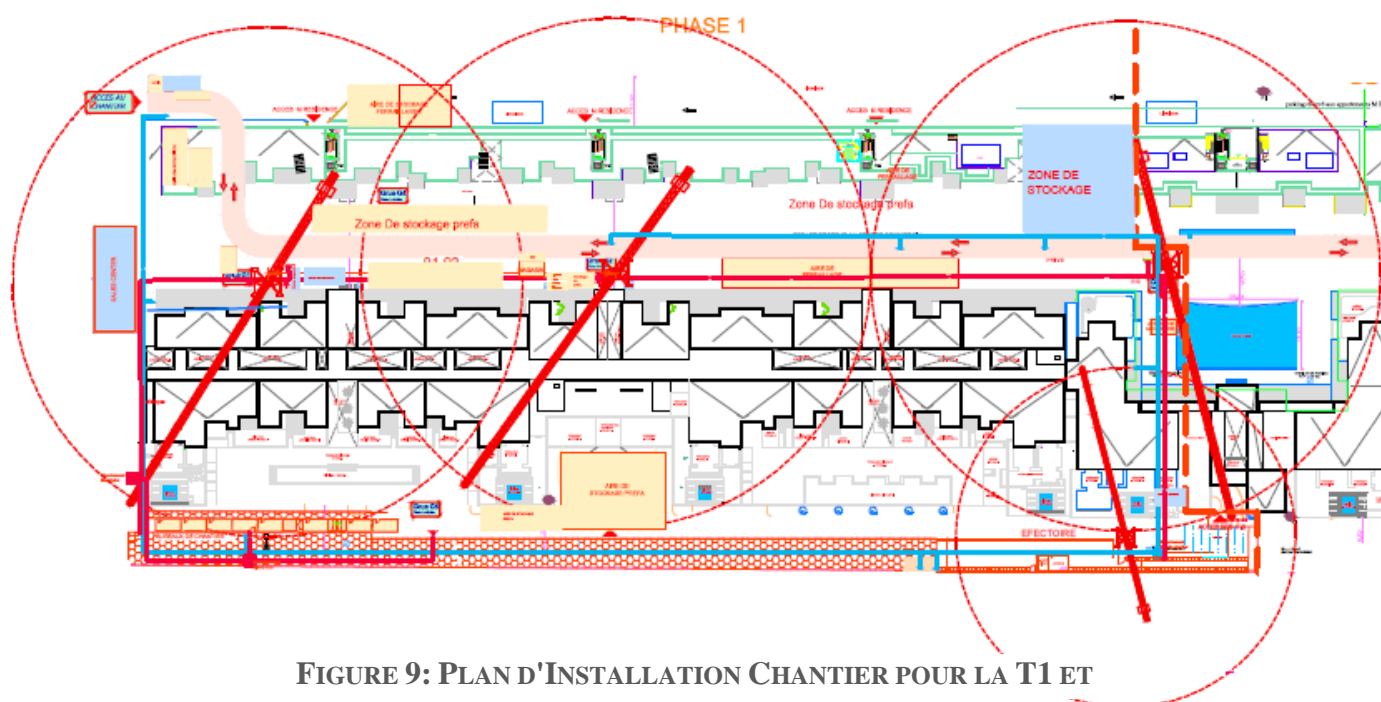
PLAN D'INSTALLATION CHANTIER POUR LA T1 ET
